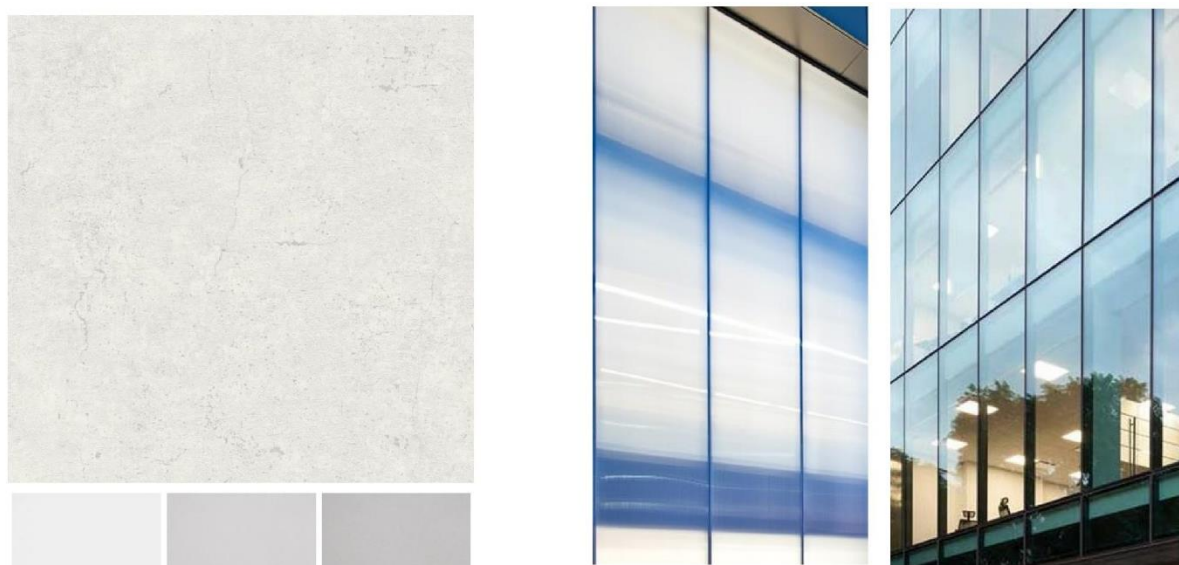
Exemples de panneaux béton pour le rez-de-chaussée (à gauche) et de panneaux vitrés pour les bureaux et circulations (à droite)
